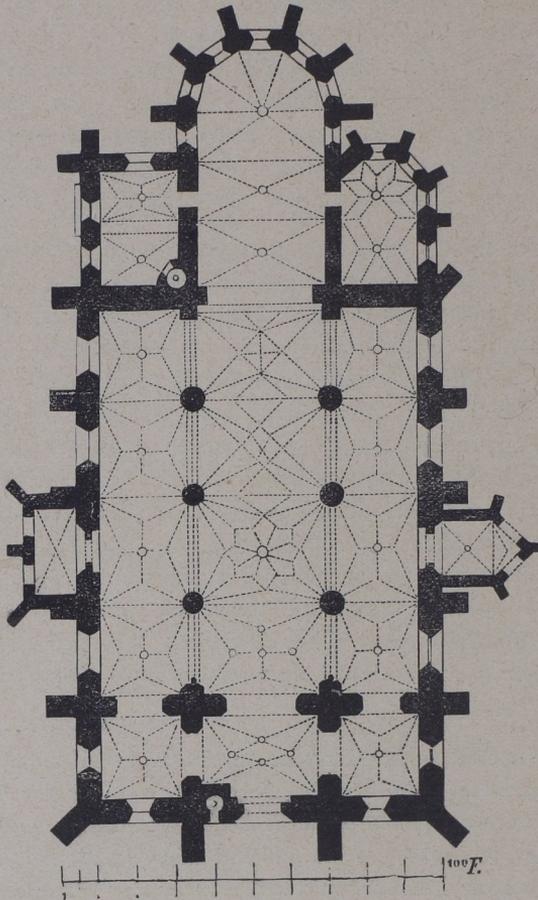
Grundriss der Erzdechanteikirche in Pilsen.
